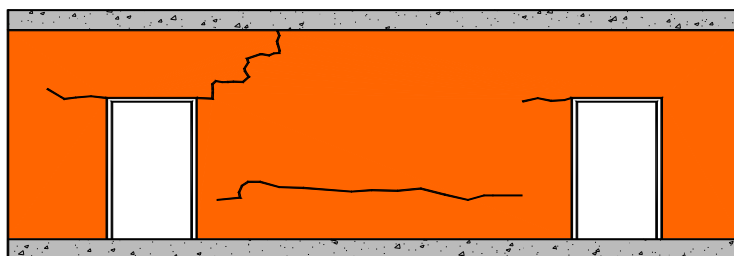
Fissuras em parede com aberturas, causadas pela deformação dos componentes estruturais [30]
